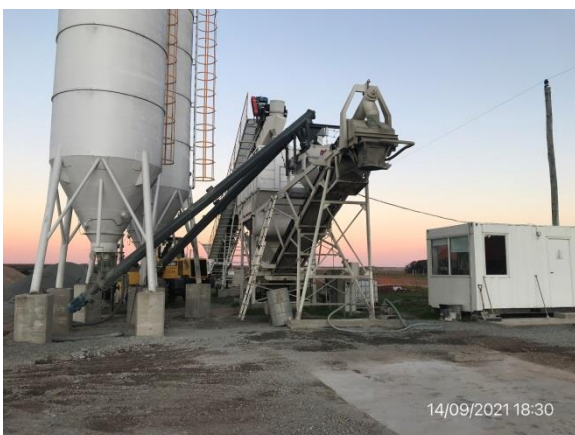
P04, Obrador principal. Planta de hormigón
